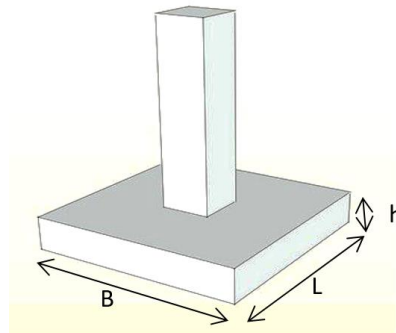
diseño de zapatas empleadas para ambas estructuras
